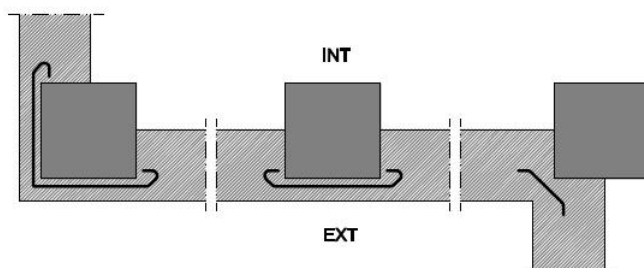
Ejemplo de encuentro de la fachada con los pilares
